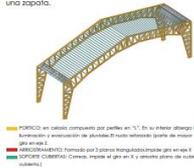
Modelado de pórticos Naves Ecuacerámica
